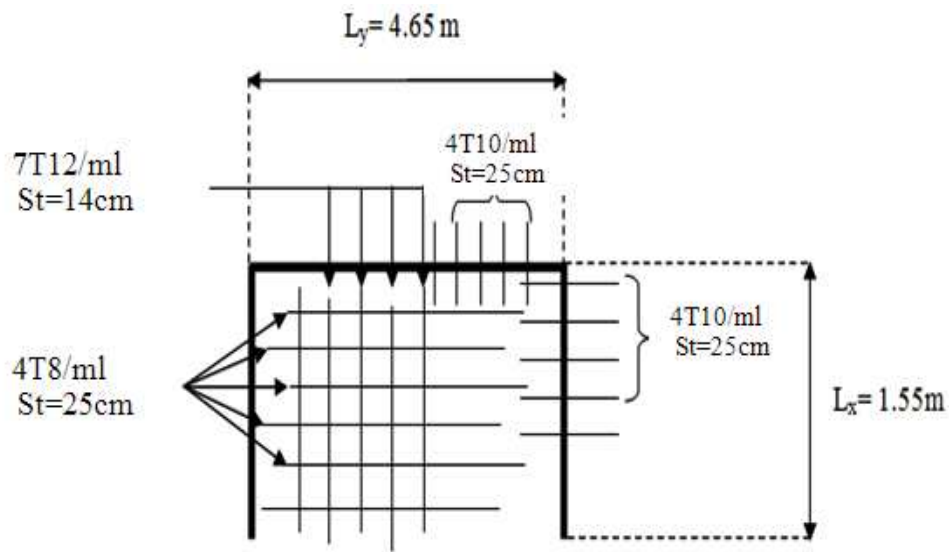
Schéma de ferrailage de la dalle sur trois appuis
